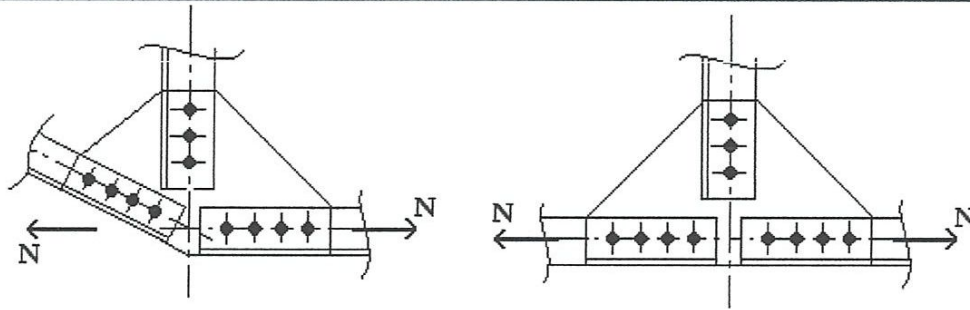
goussets de poutres treillis travaillant en flexion.
